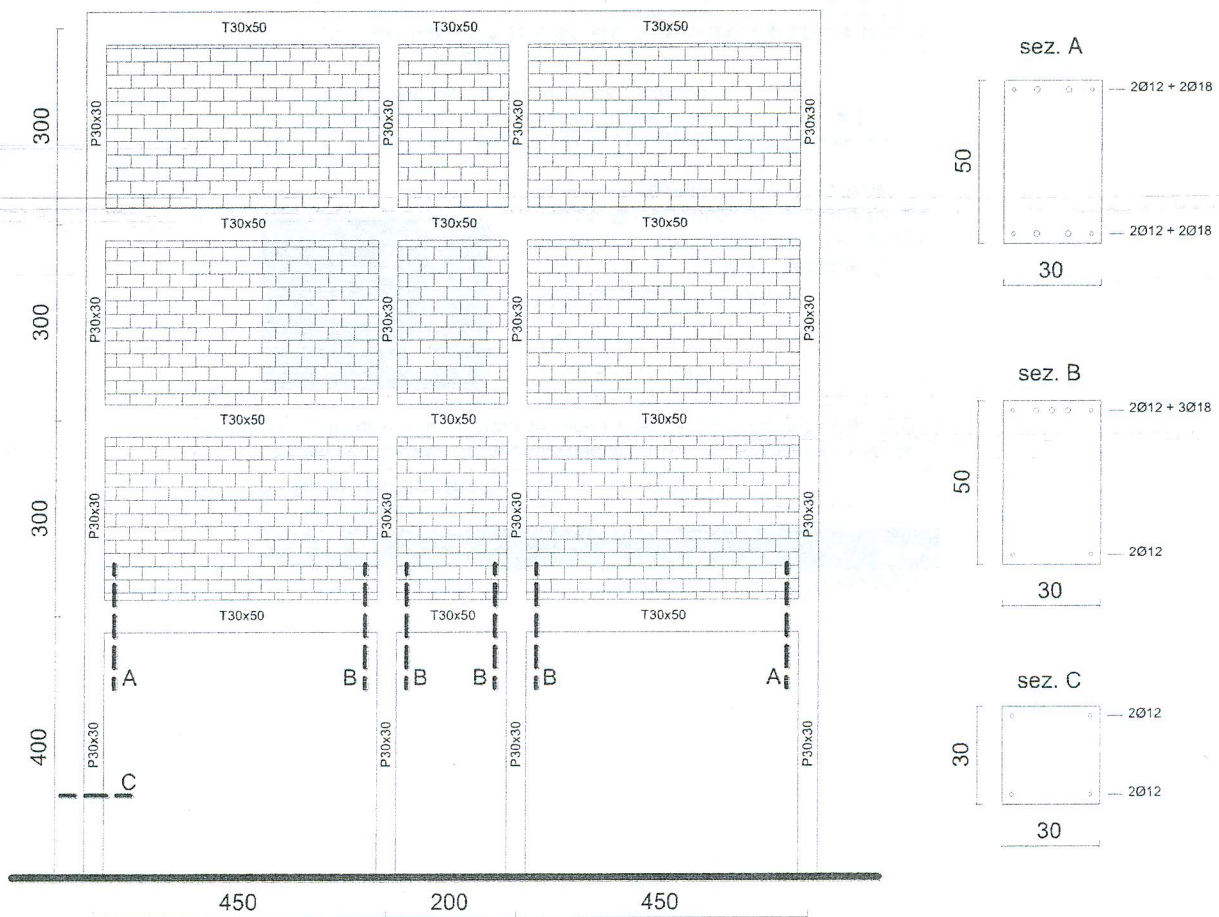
Geometria del telaio di bordo ed armature delle sezioni principali di travi e pilastri.
